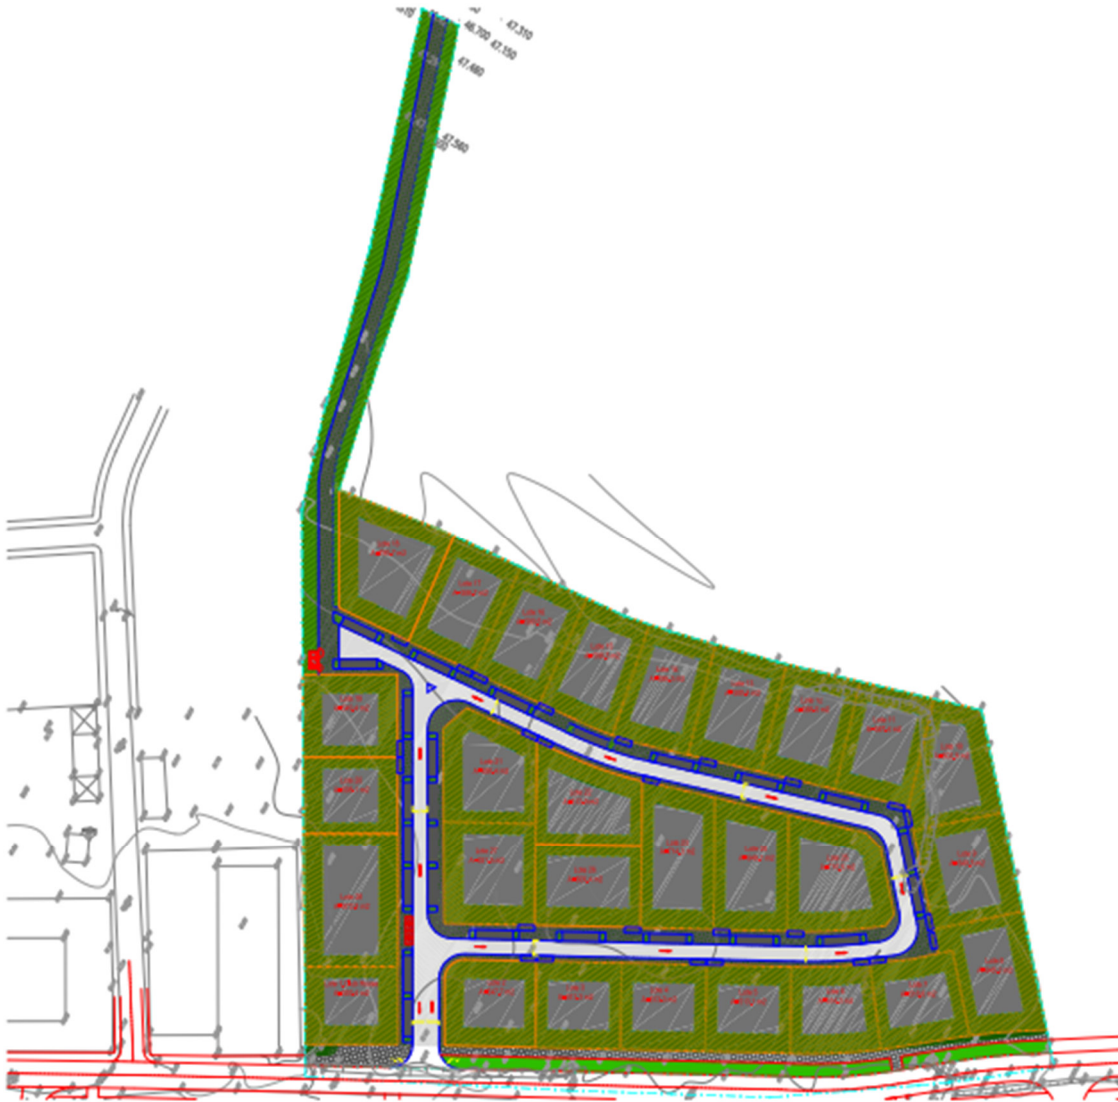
Enquadramento do loteamento a construir (Arquitetura)
